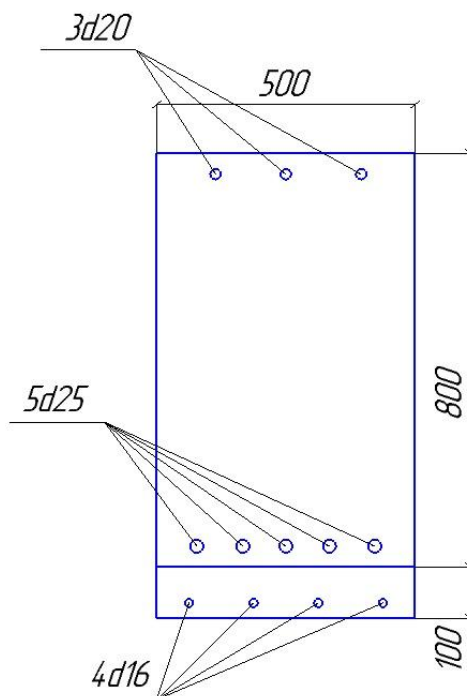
Рассчитываемое железобетонное сечение
